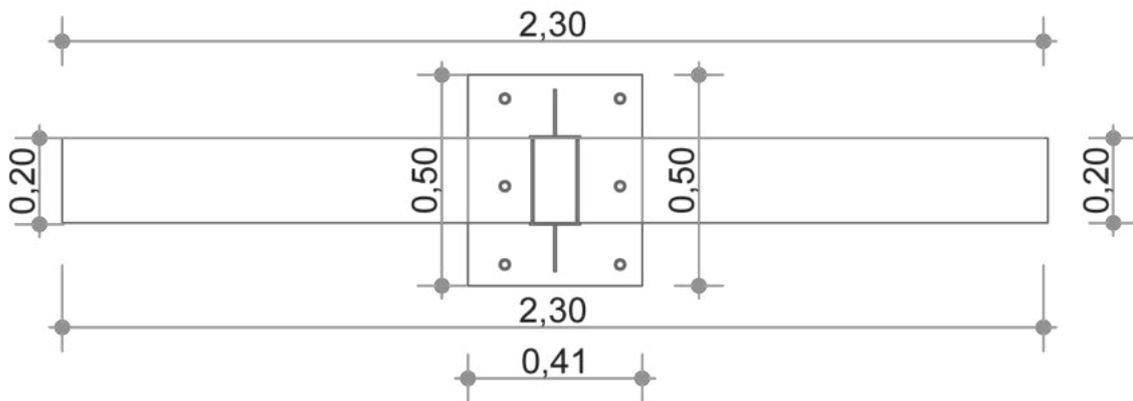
Planos 13 – planta arquitectónica de lámpara. Fuente: Elaboración propia Nota: Luminaria ubicada en todo lo que conforma el parque lineal sujetas con una placa metálica en la parte inferior con pernos autoperforantes
